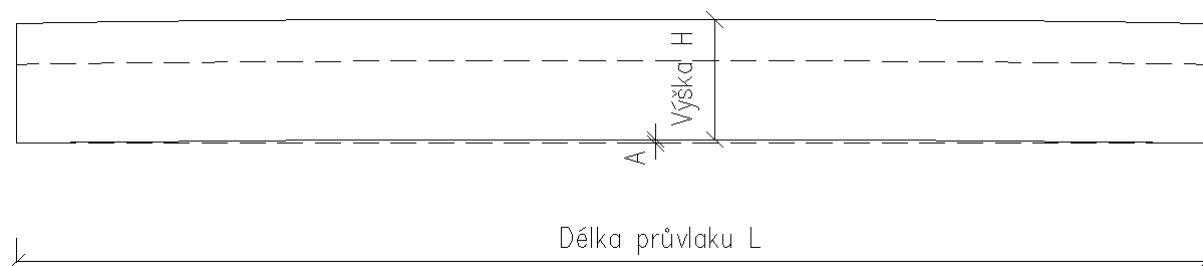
Výrobní tolerance průvlaku
